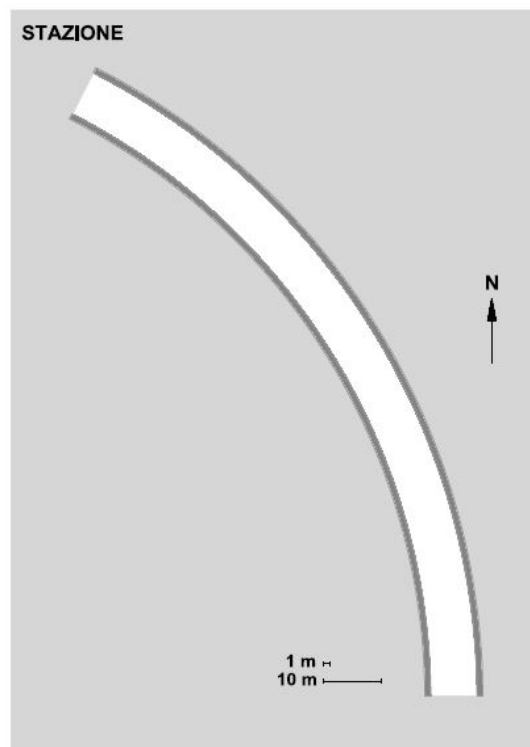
planimetria della galleria di Framura (SP) per test di navigazione indoor
